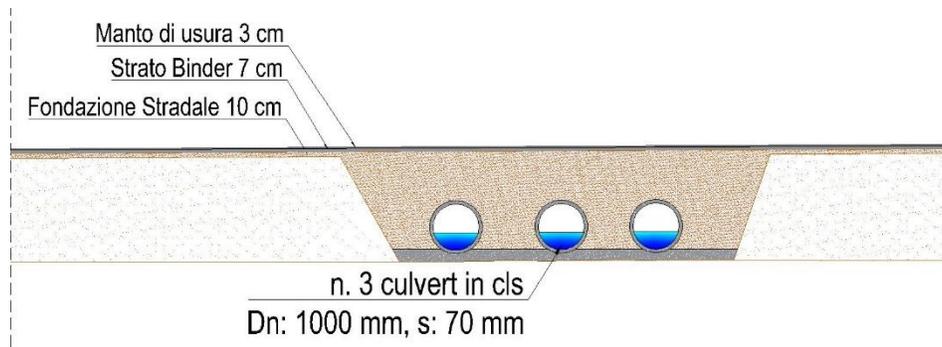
Sezione all'Attraversamento con la Strada Comunale
